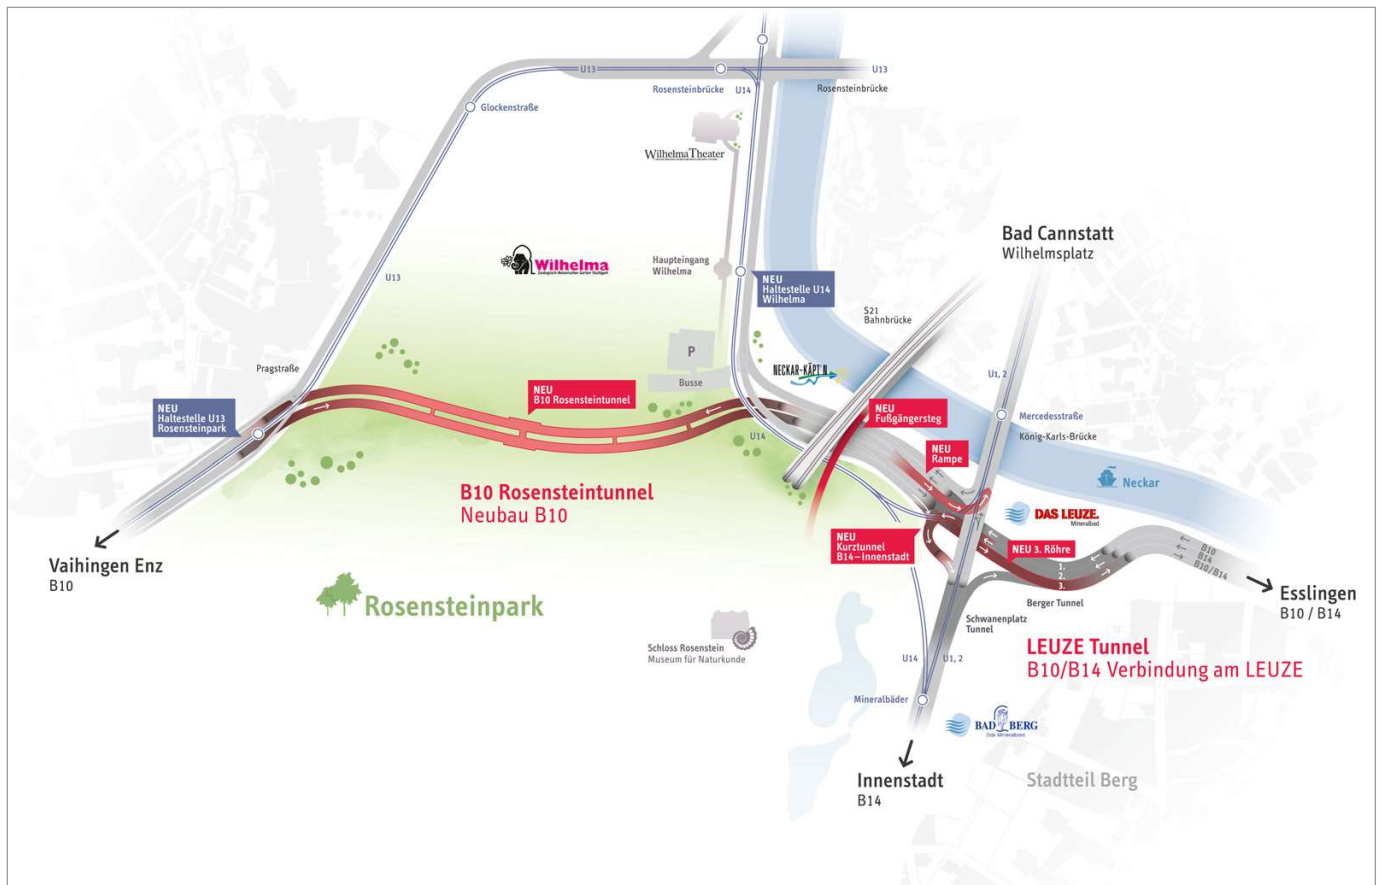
Übersicht Straßenbauprojekt B 10-Rosensteintunnel
